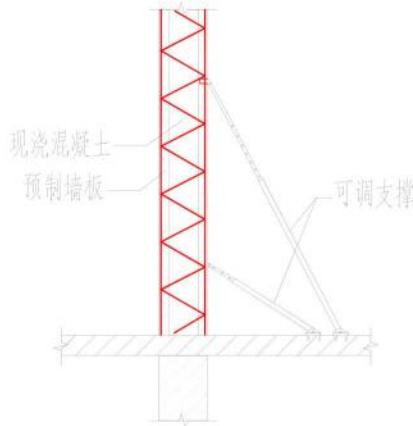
预制混凝土叠合剪力墙单元构件的斜撑固定
